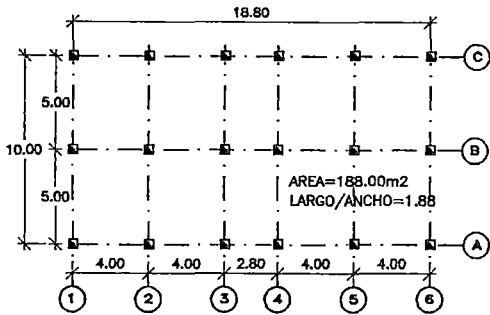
DIMENSIONES M01 PLANTA TIPICA
